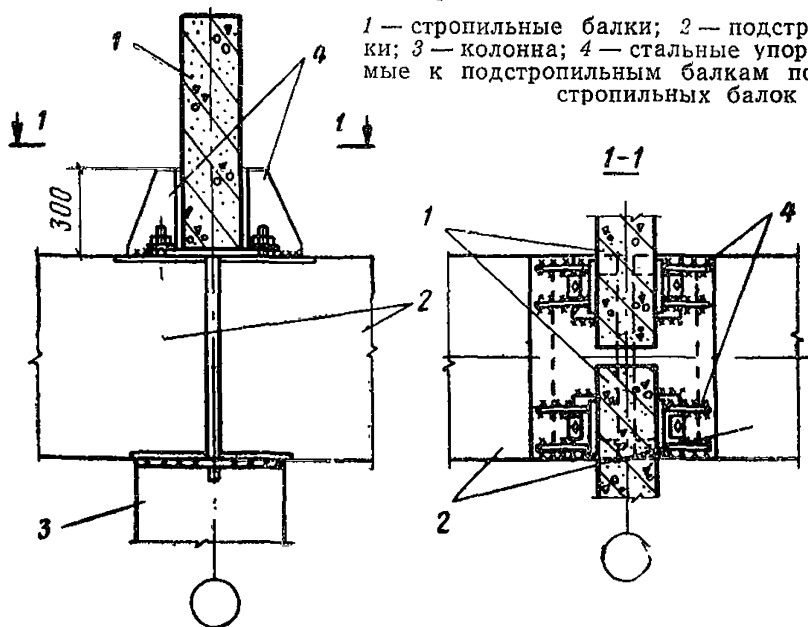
Крепление стропильных балок к подстропильной в середине ее пролета (при скатной кровле) в зданиях с расчетной сейсмичностью 8 баллов
